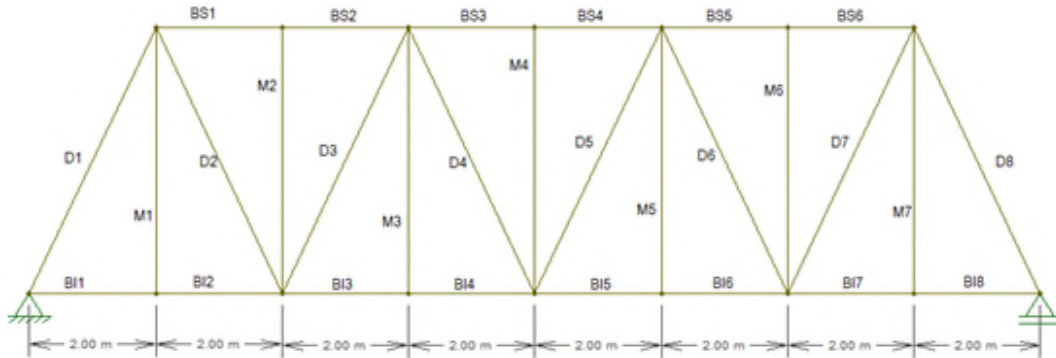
Descrição dos elementos da viga principal. Fonte (Autor)
